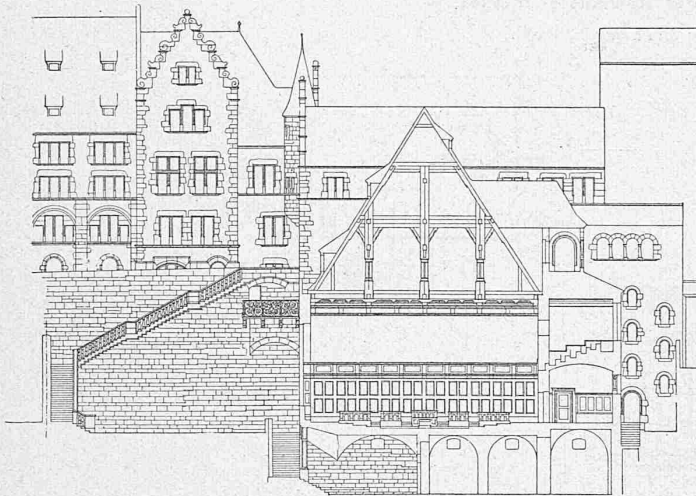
Schnitt E-F (Siehe Lageplan Fig. 1). 1 : 500.
